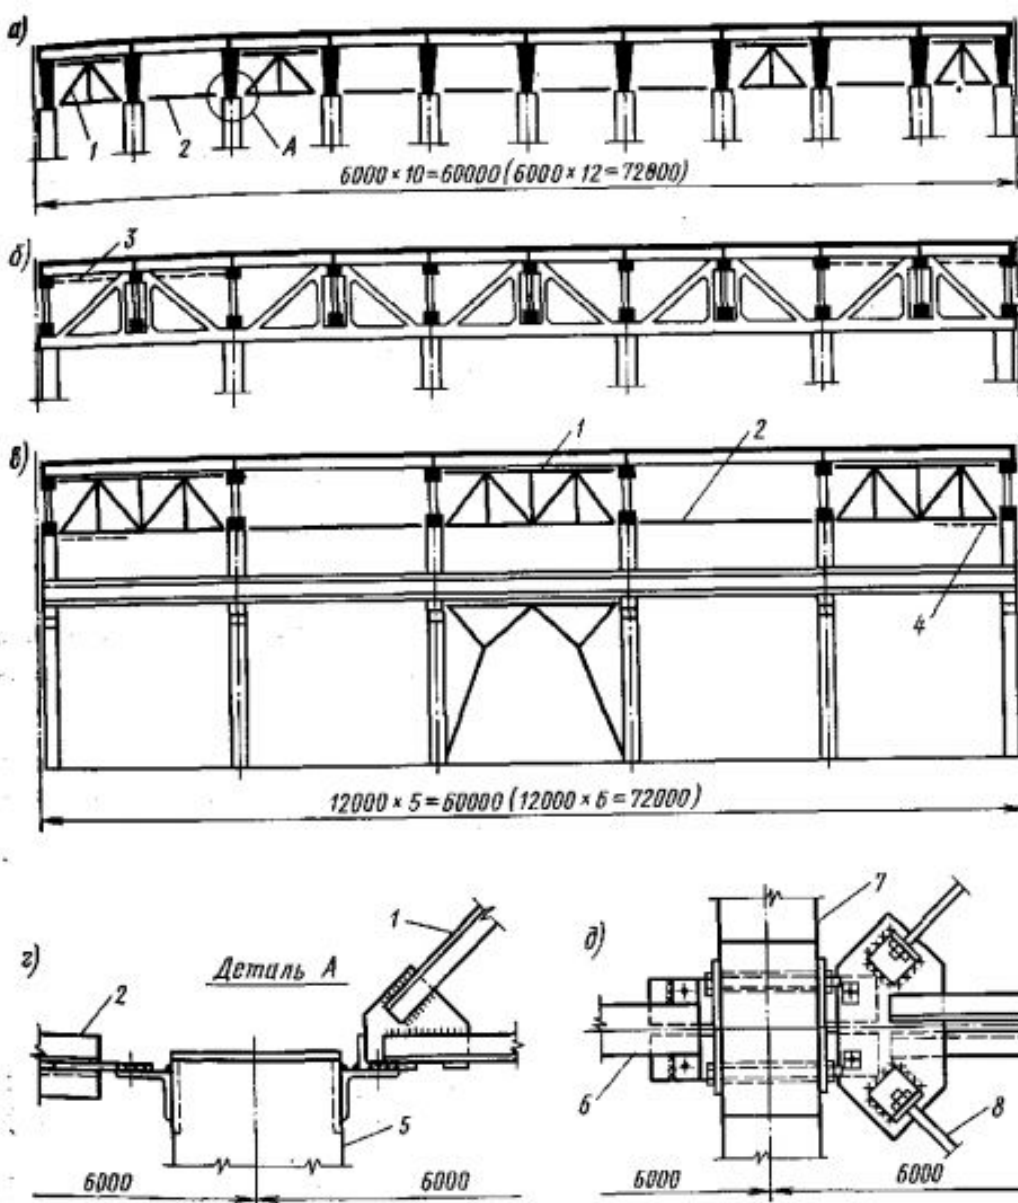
Связи в покрытиях при железобетонных фермах:
